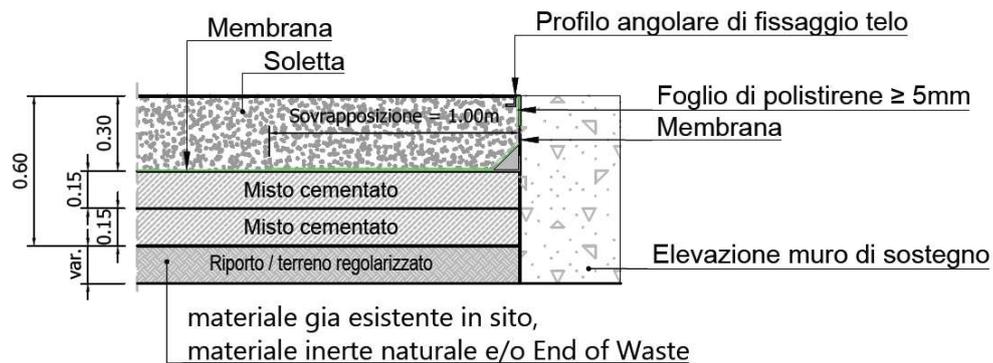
Particolare fissaggio geomembrana a muro di sostegno
